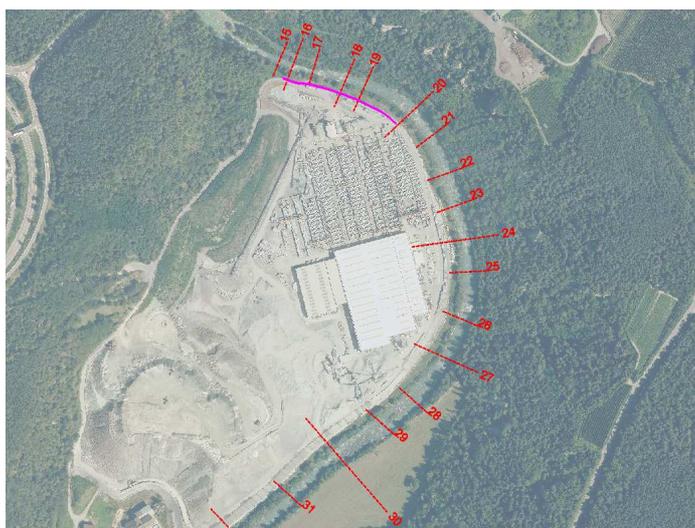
Localizzazione della barriera di protezione presso il deposito Hinterrigger tra le sezioni 15 e 20.
